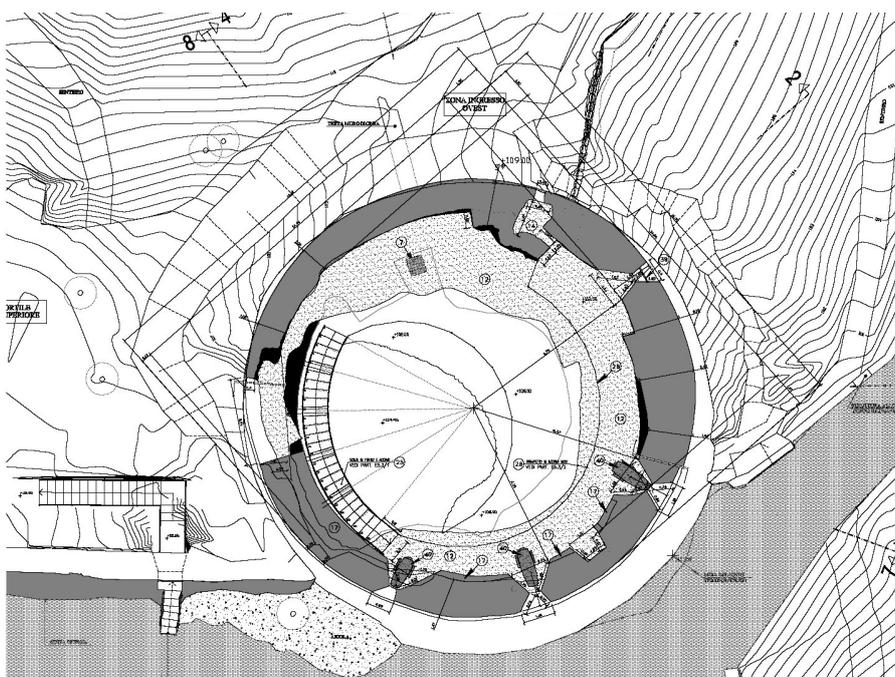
Progetto di restauro: planimetria del terzo livello.
